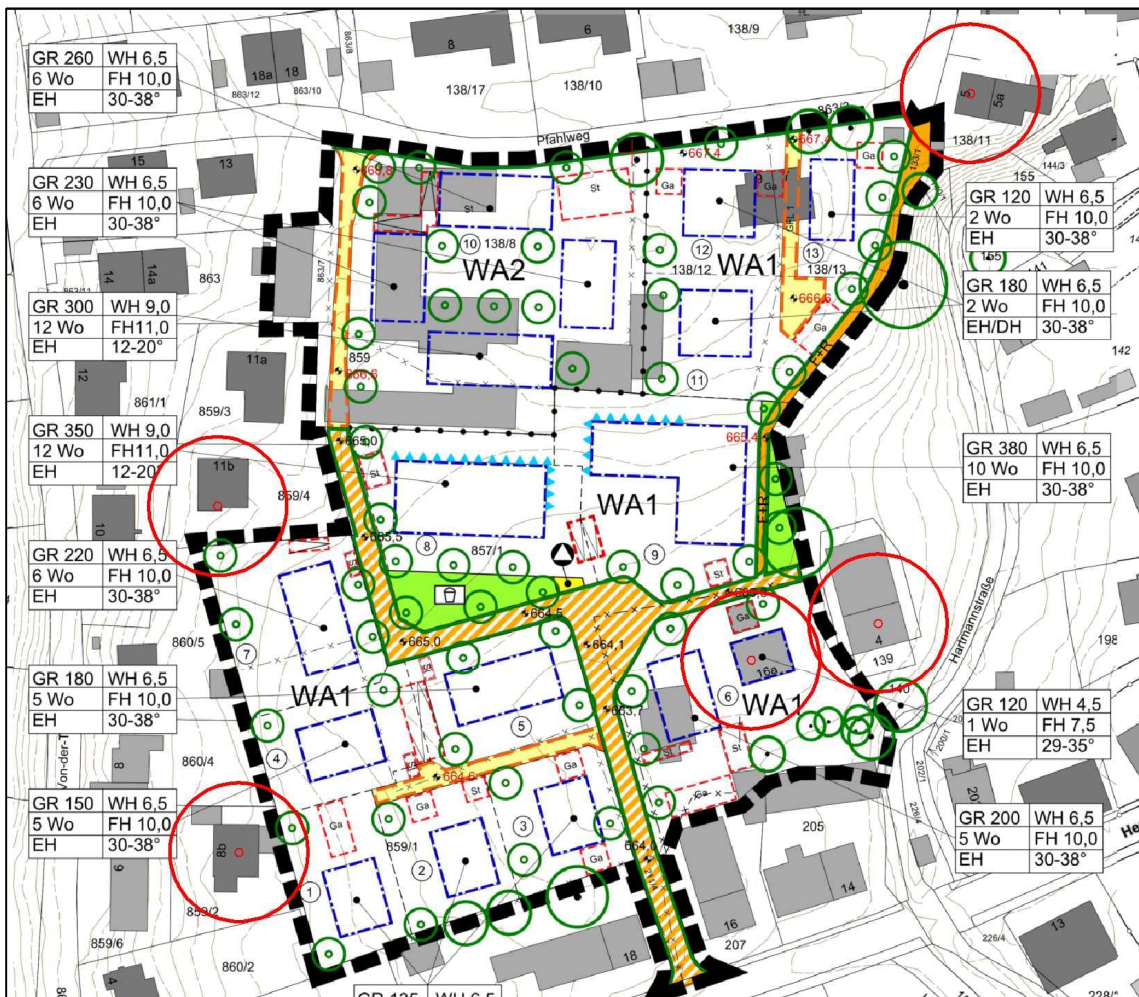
Lageplan mit Darstellung der Mindestabstände der 1. BImSchV (rote Kreise)
